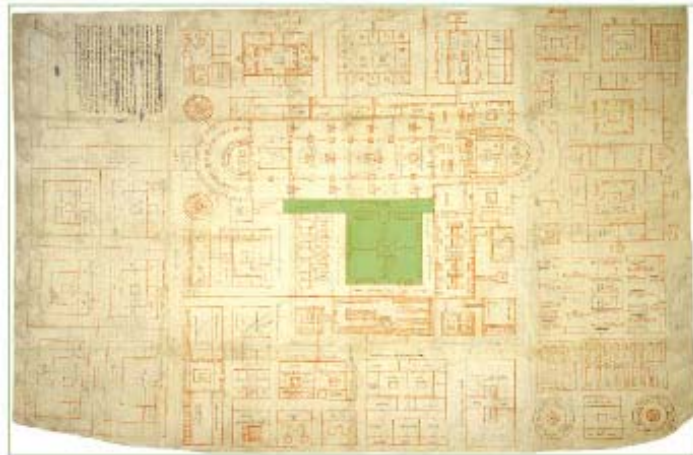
Klosterplan, Planausschnitt Eingang Klausur, nördl. Kreuzgang und Kreuzganggarten
